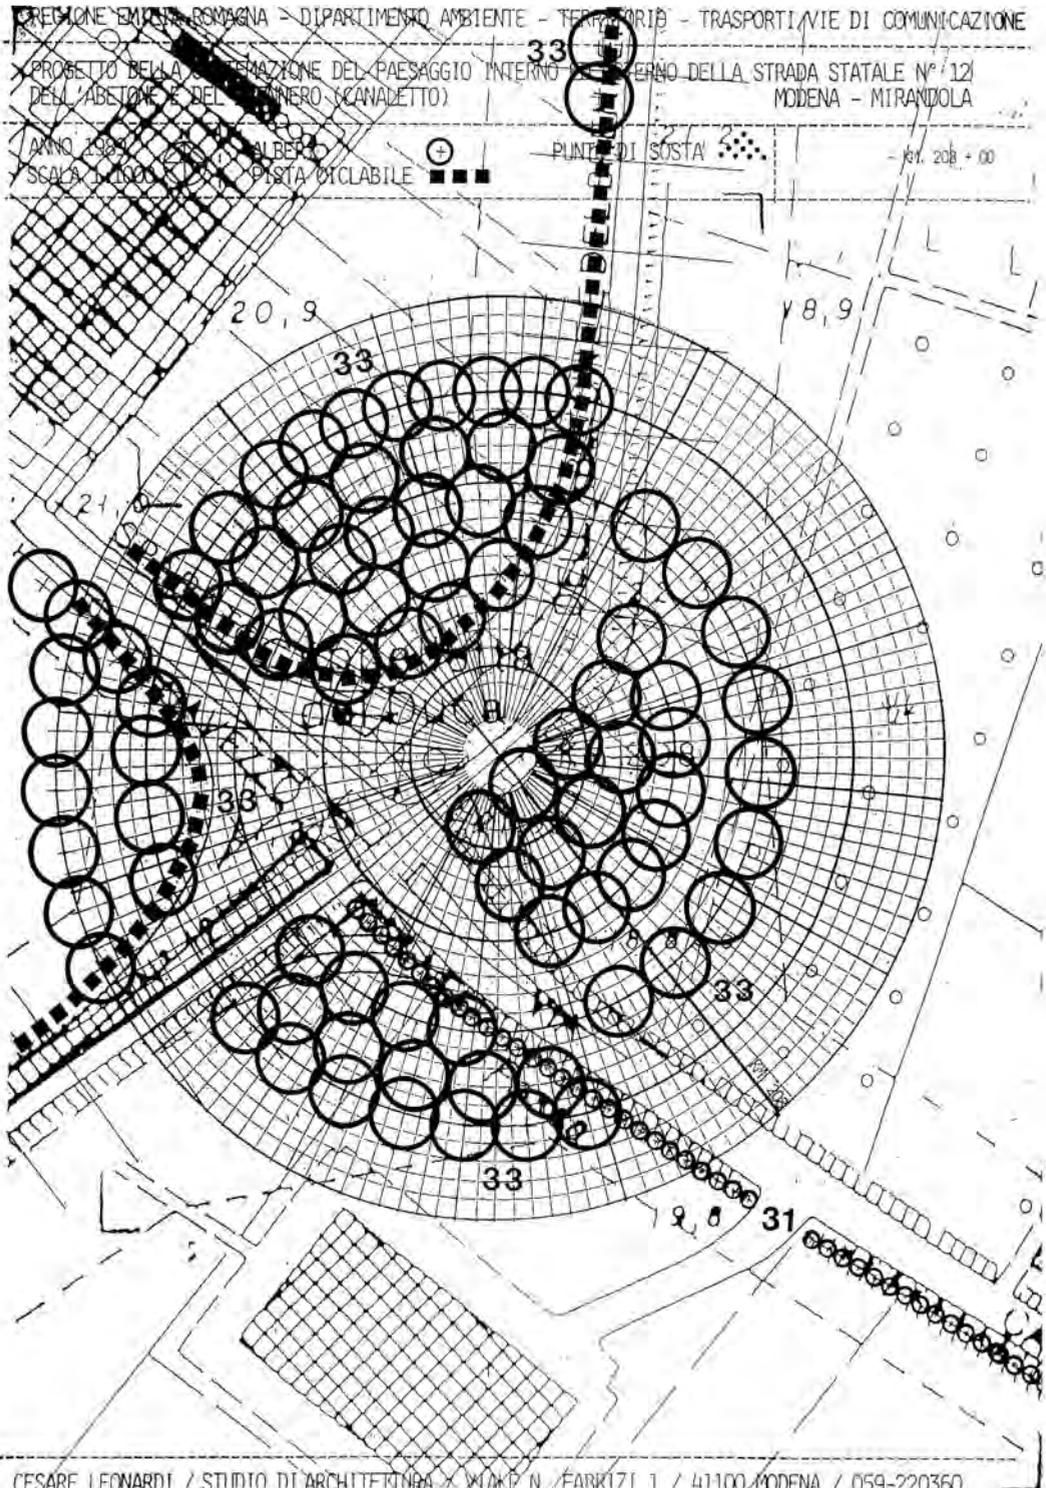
Schema d'impianto delle alberature lungo la SS Canaletto Modena-Mirandola (Archivio Architetto Cesare Leonardi).
